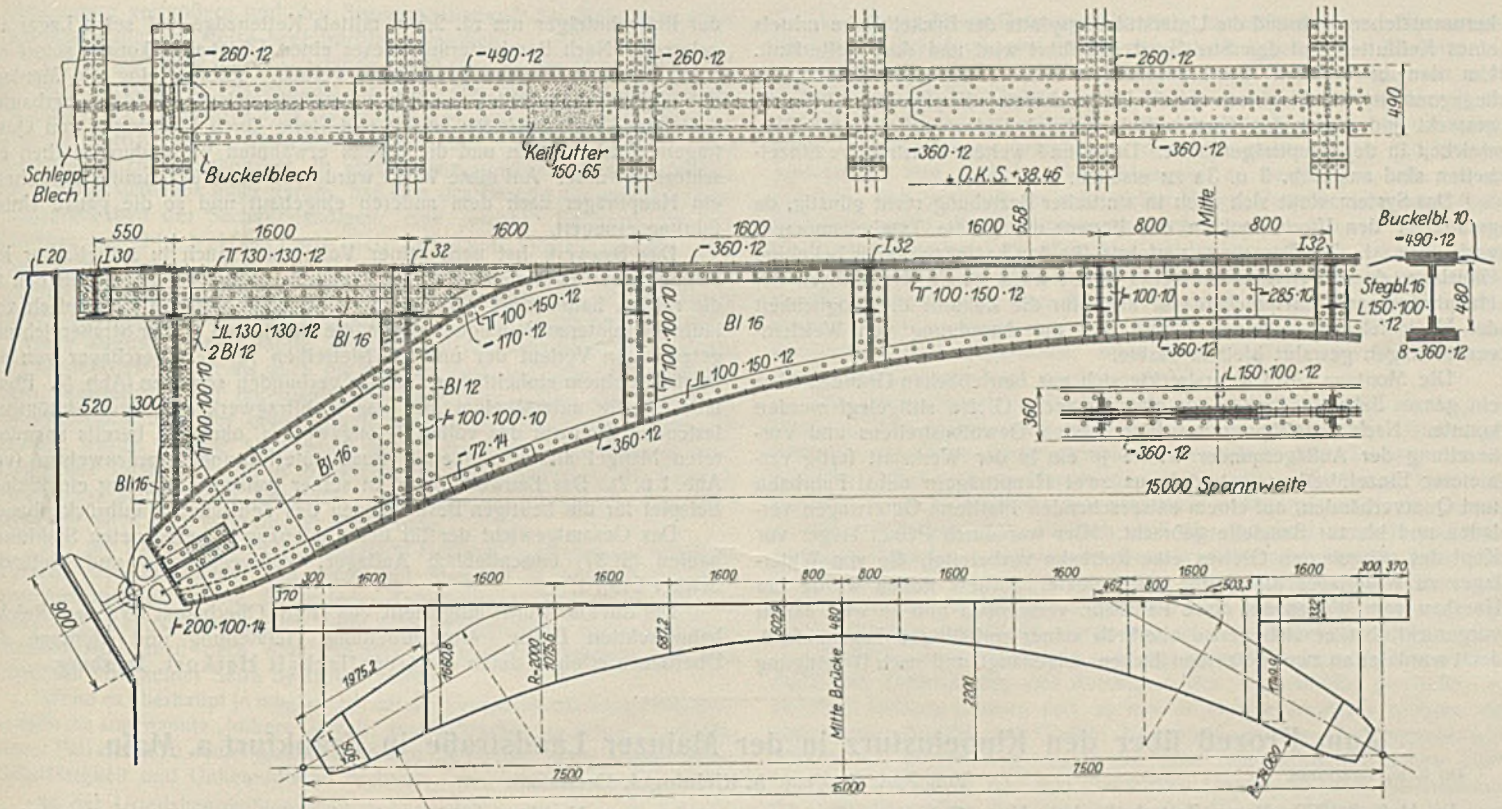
Konstruktive Durchbildung des Hauptträgers.
